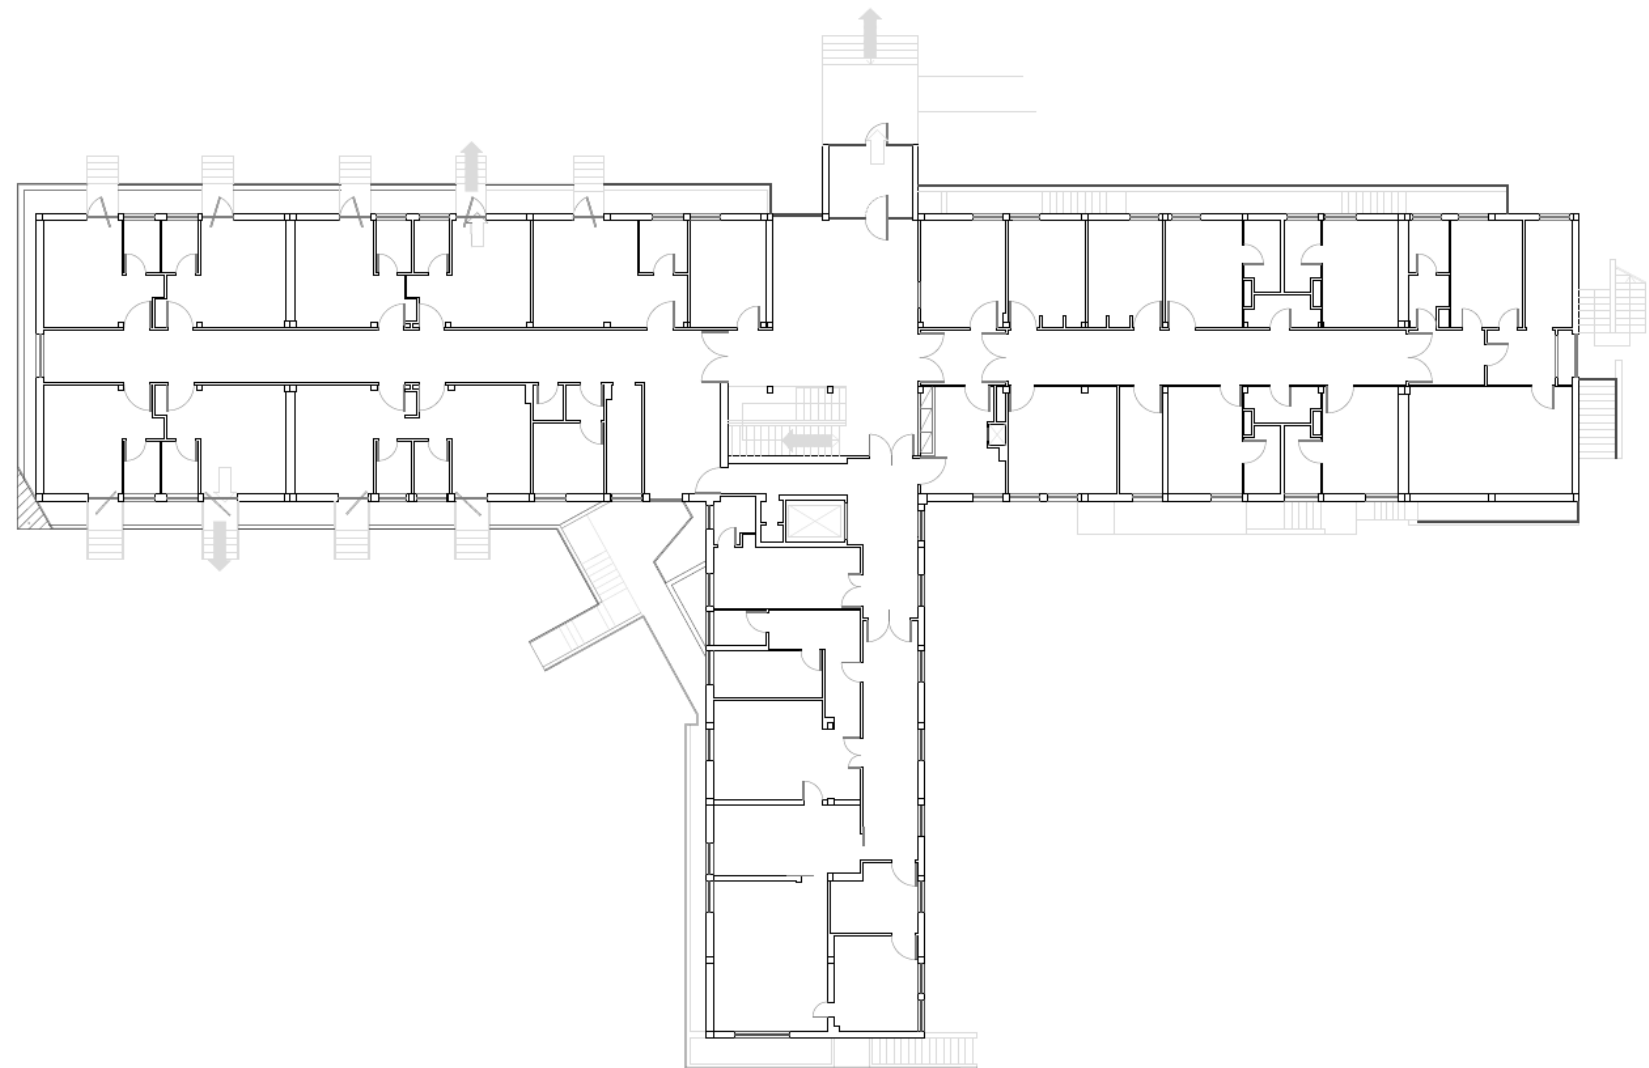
EX CLINICA BELVEDERE - PIANO RIALZATO
